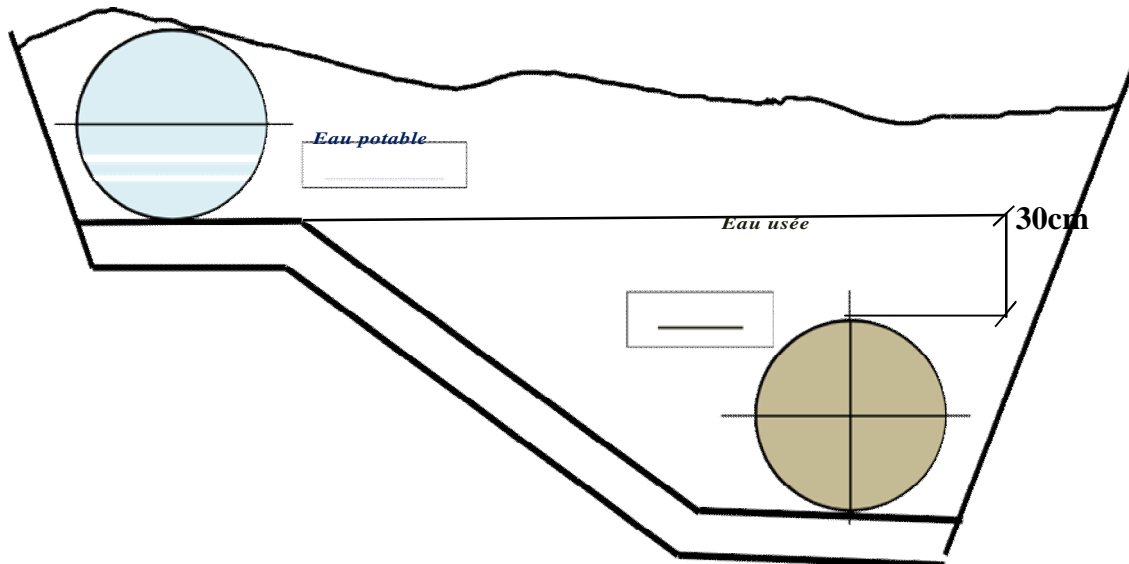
Pose à proximité d'une conduite d'assainissement.
